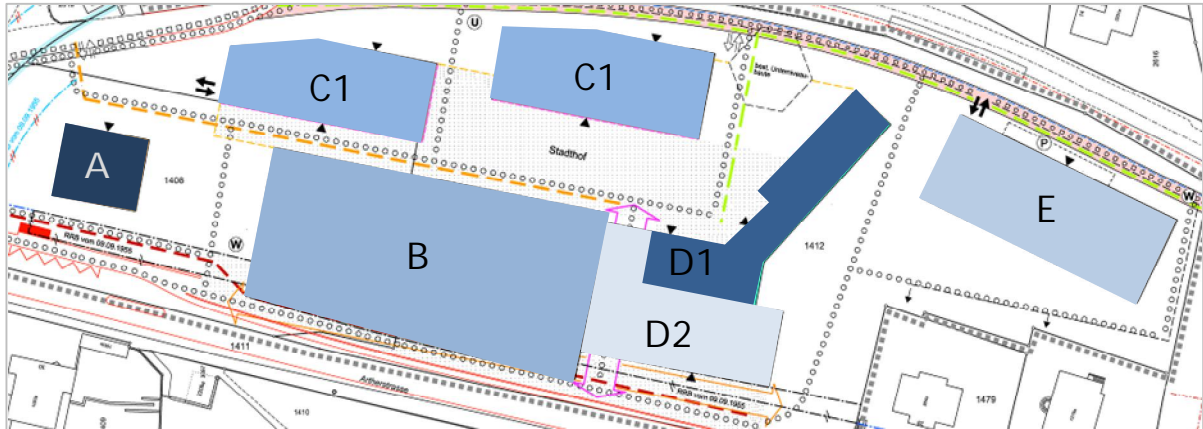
Ausschnitt der Baubereiche aus dem Bebauungsplan, ohne Masstab
